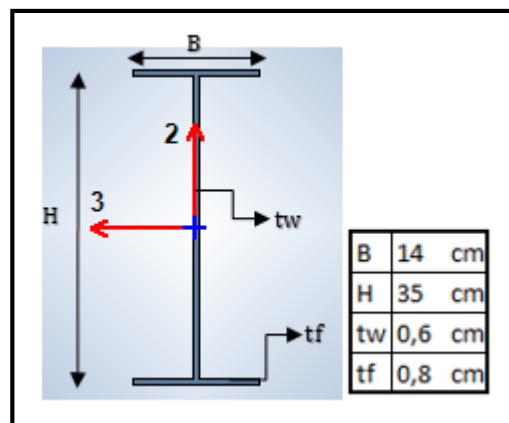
Dimensiones de Vigas centrales en "Y" con pórticos arriostrados, planta de cubierta
